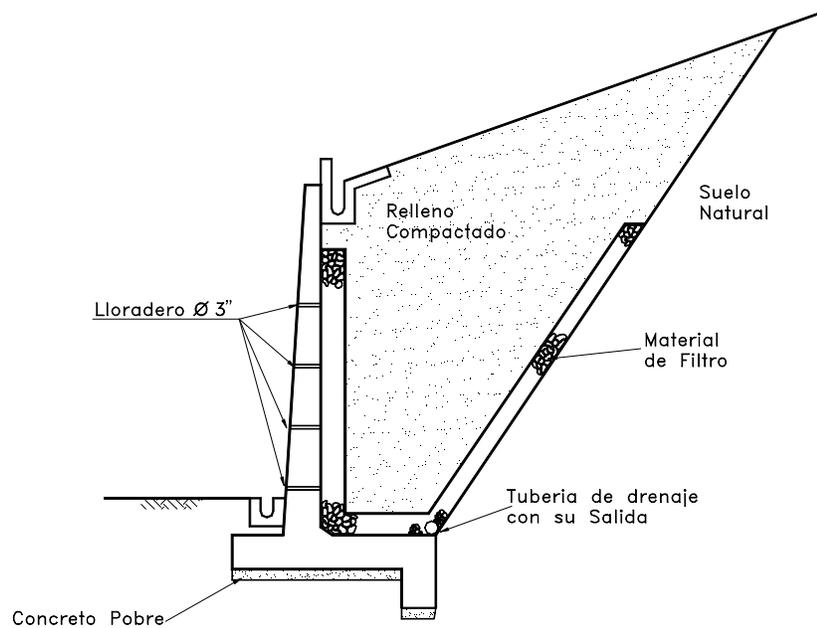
Esquema típico de un muro de concreto armado con su sistema de subdrenaje
